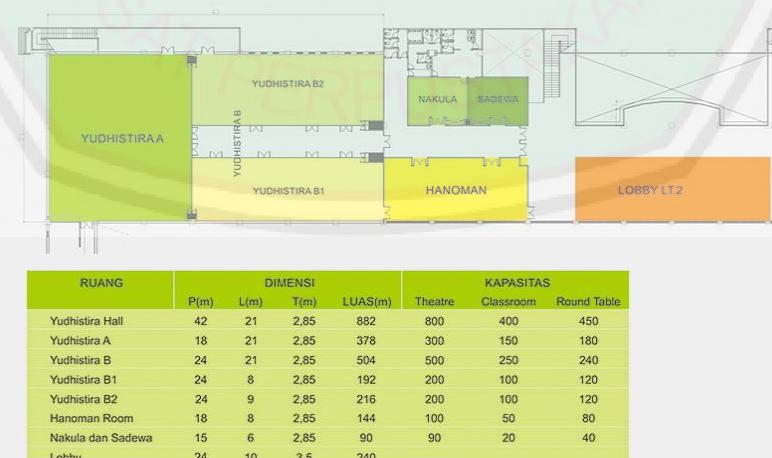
Floor Plan Lt. 2 Arjuna Hall.
